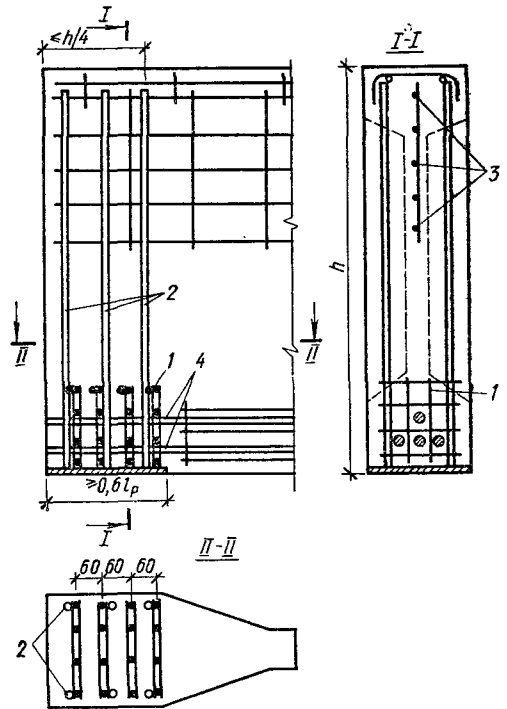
Армирование конца ребра плиты перекрытия:
